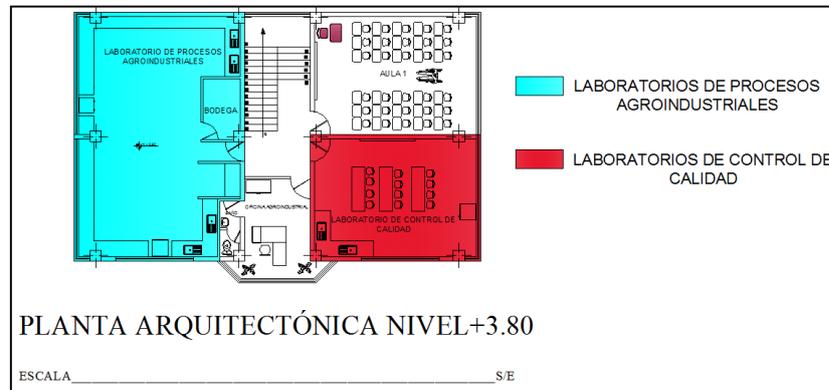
Laboratorios de Agroindustrial en la primera planta alta del Bloque D
